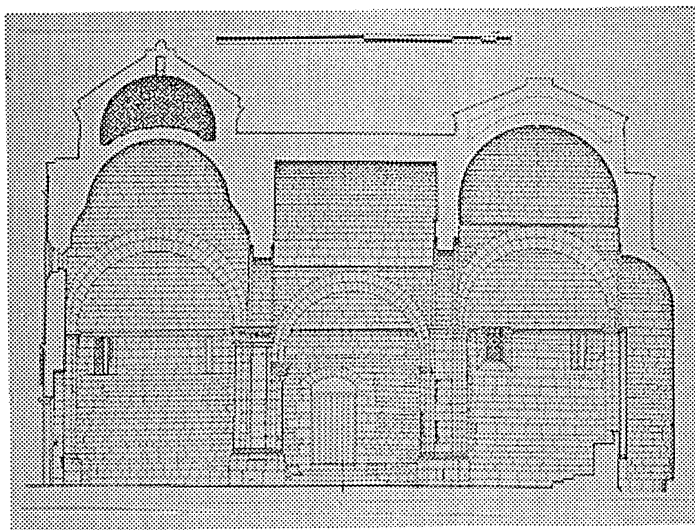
San Leonardo, sezione longitudinale (rilievo arch. D'Ardes).
